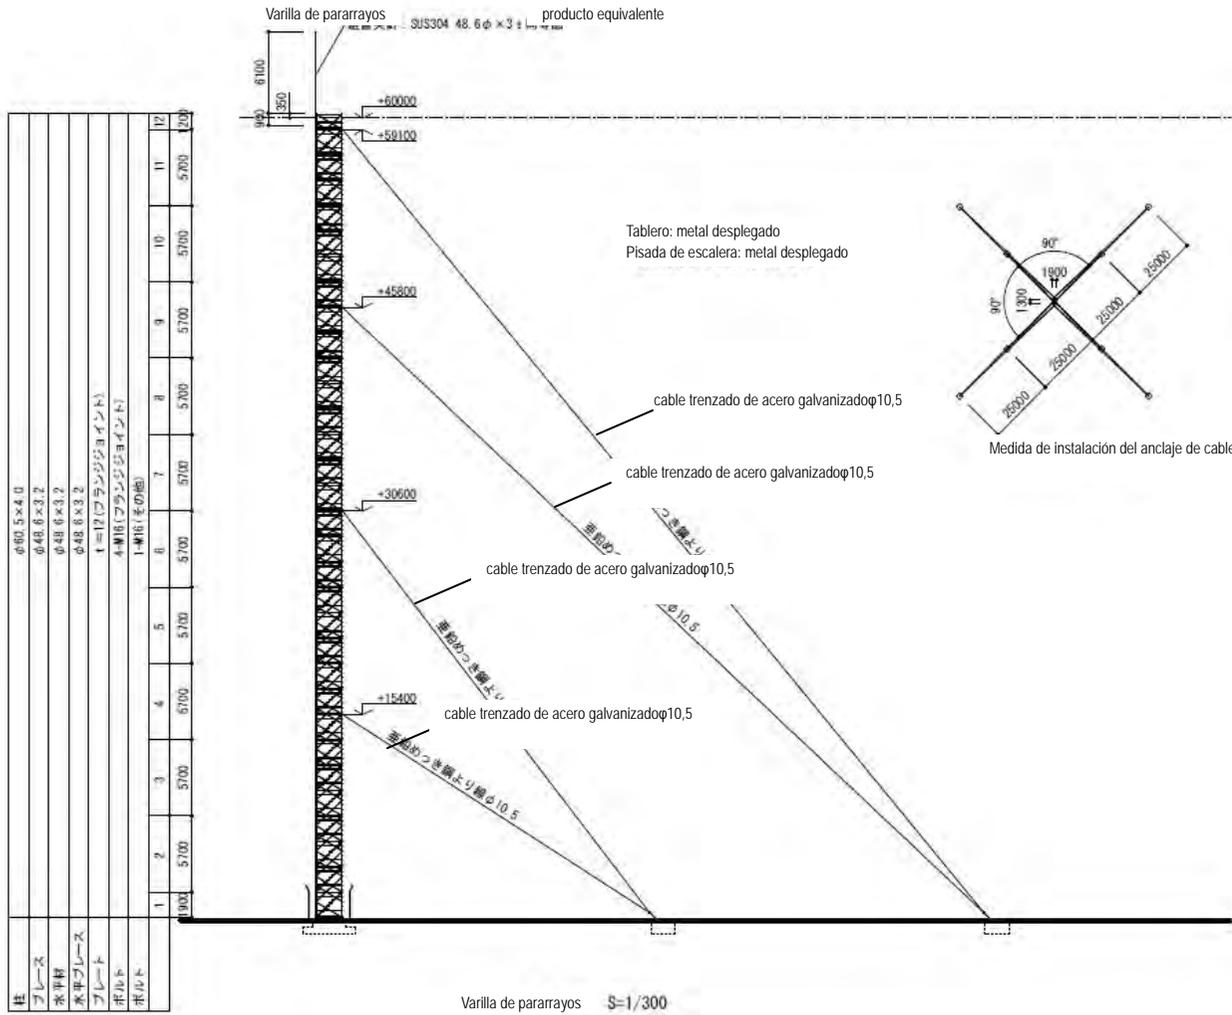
Vista Alzada de la Torre (h=60m) (plano referencial)
